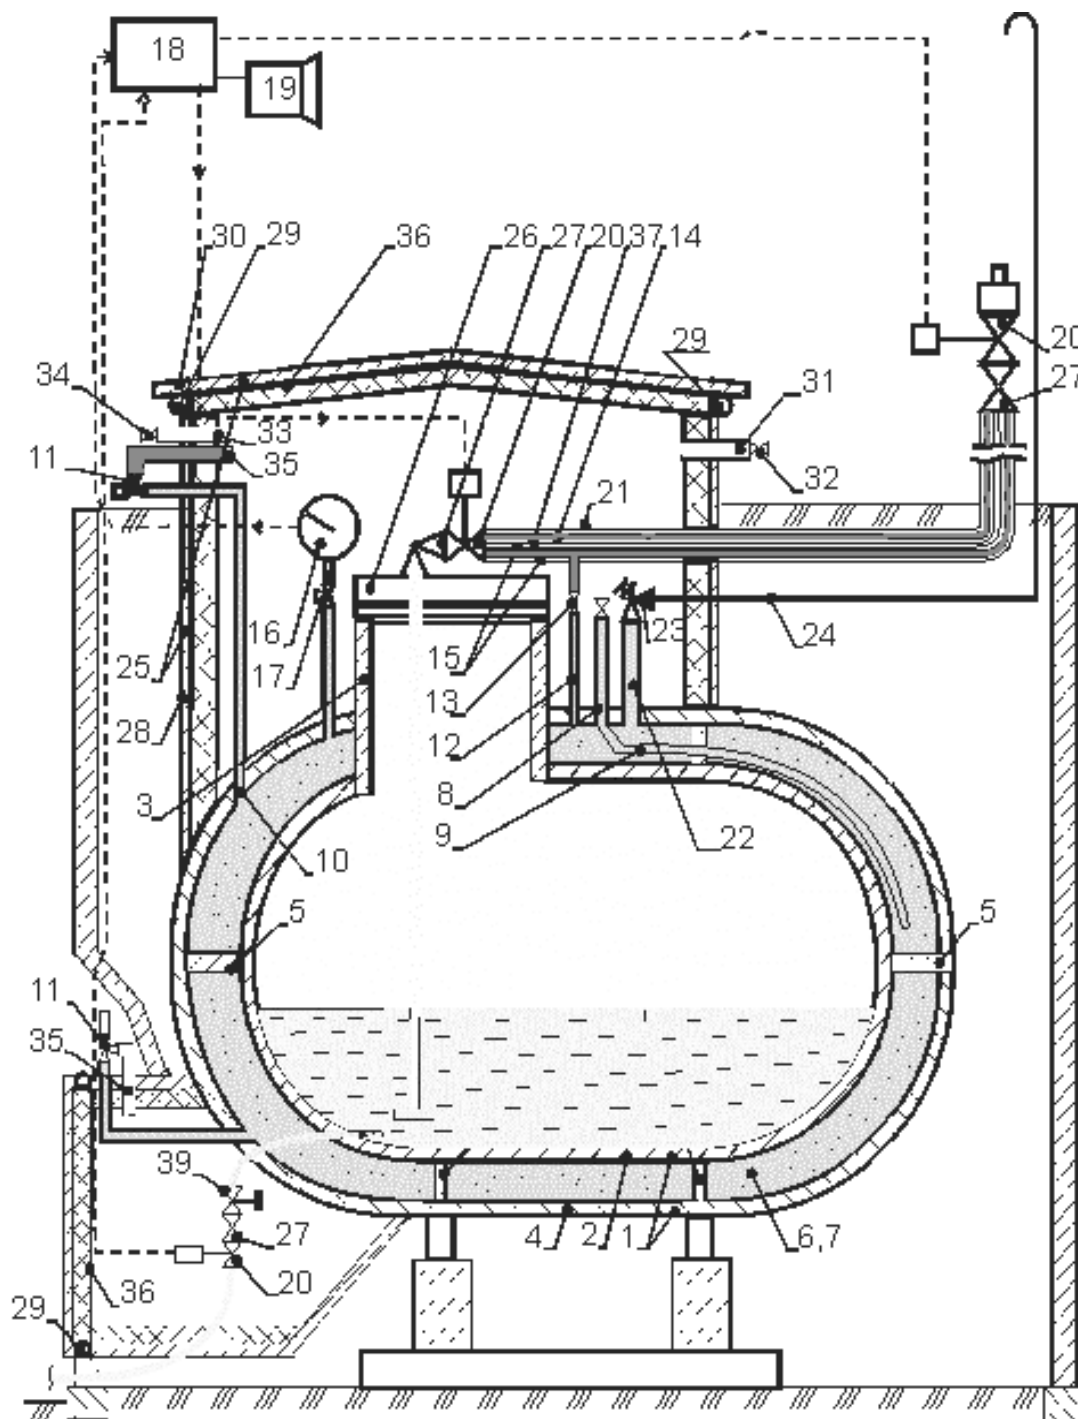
Схема надземной горизонтальной установки двустенного резервуара с СУГ и засыпкой песком в постоянную опалубку из железобетонных плит
